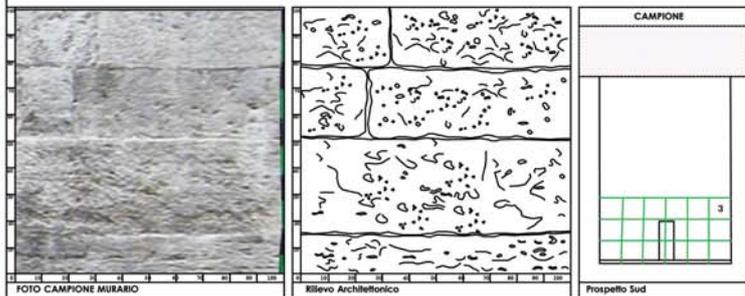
FOTO CAMPIONE MURARIO Rilievo Architettonico Prospetto Sud
